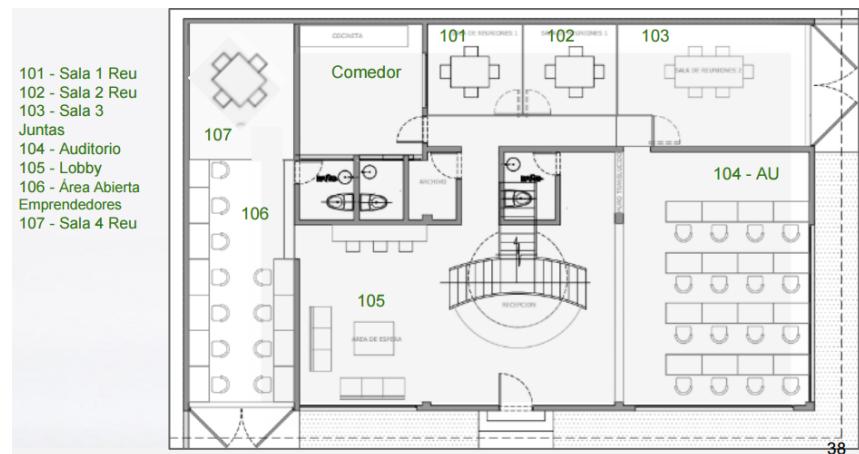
Plano de distribución primera planta. Fuente: (51)
